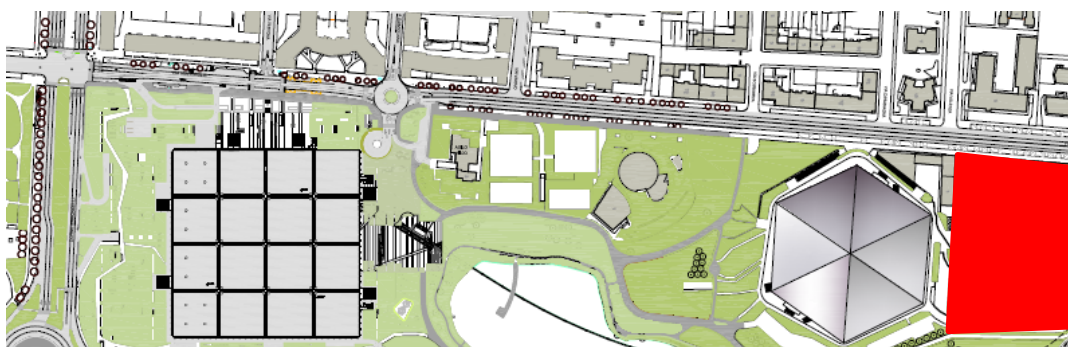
Stralcio planimetrico con identificazione degli spazi necessari al suolo
